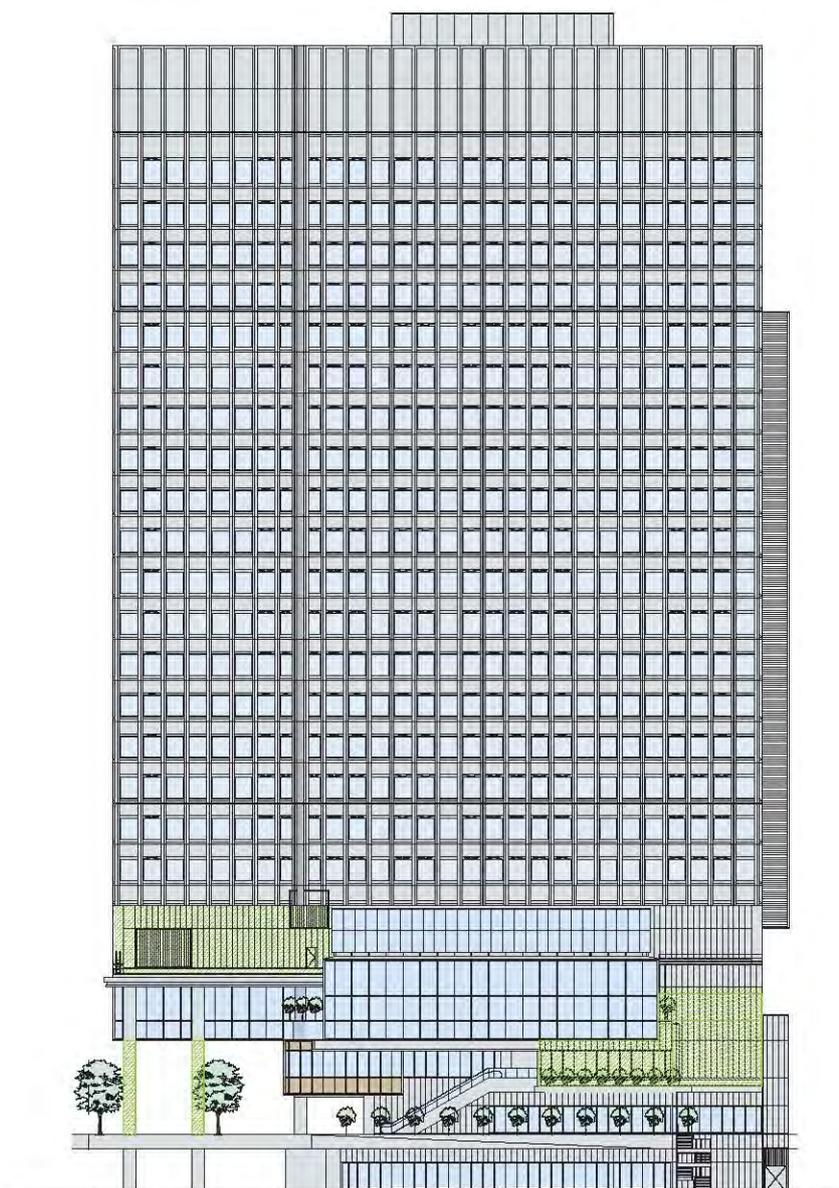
(1) 立面图 (南立面图 S=1:800) 【变更后】
